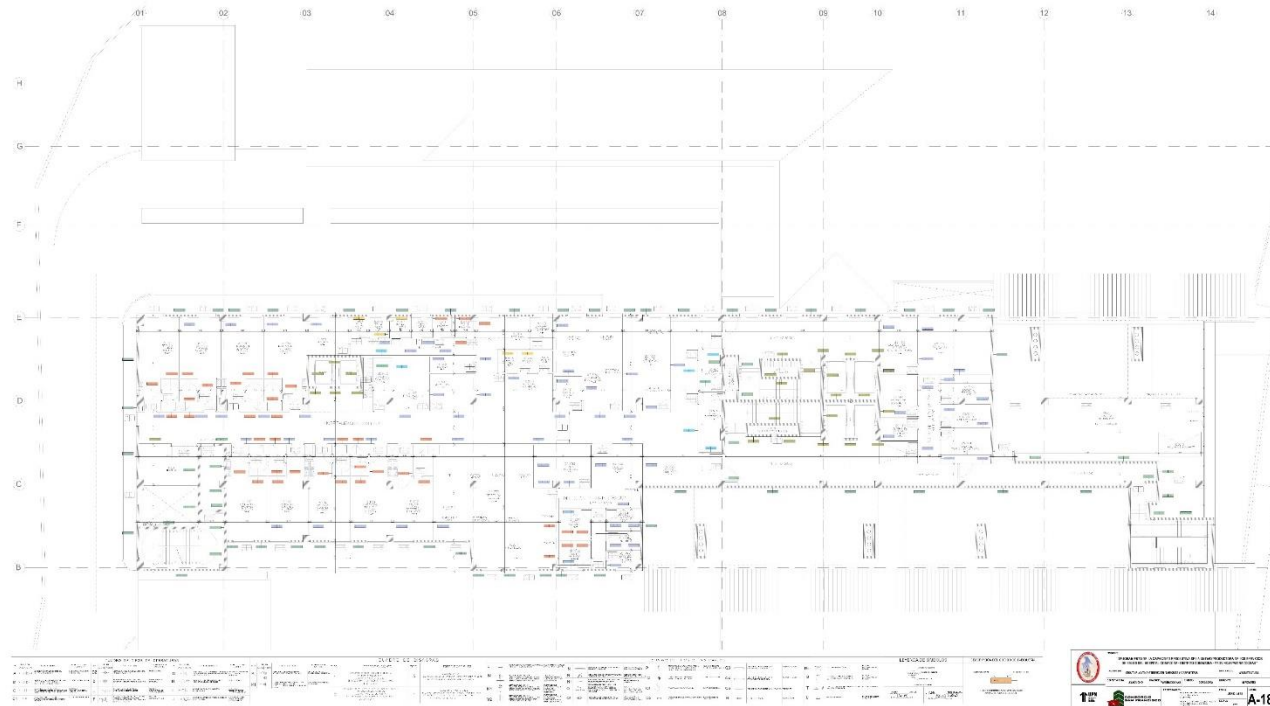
CUARTA PLANTA DISTRIBUCION
